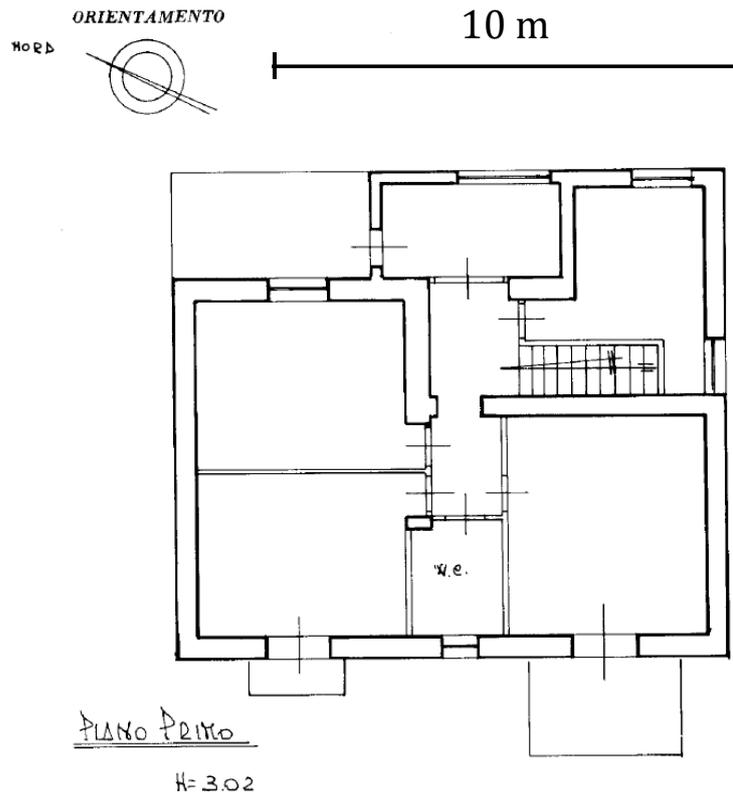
Estratto Planimetria Catastale - Abitazione di tipo civile NCEU Foglio 20, Piano 1° della part 202
